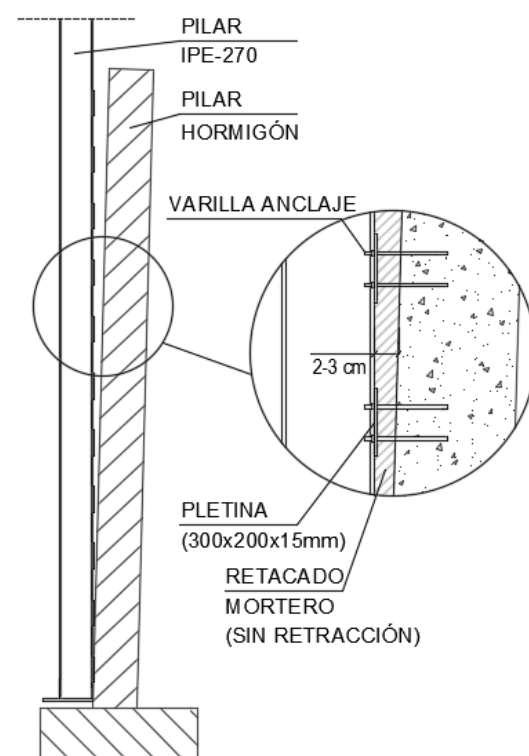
Detalle encuentro cara interior IPE-270 y pilar existente
